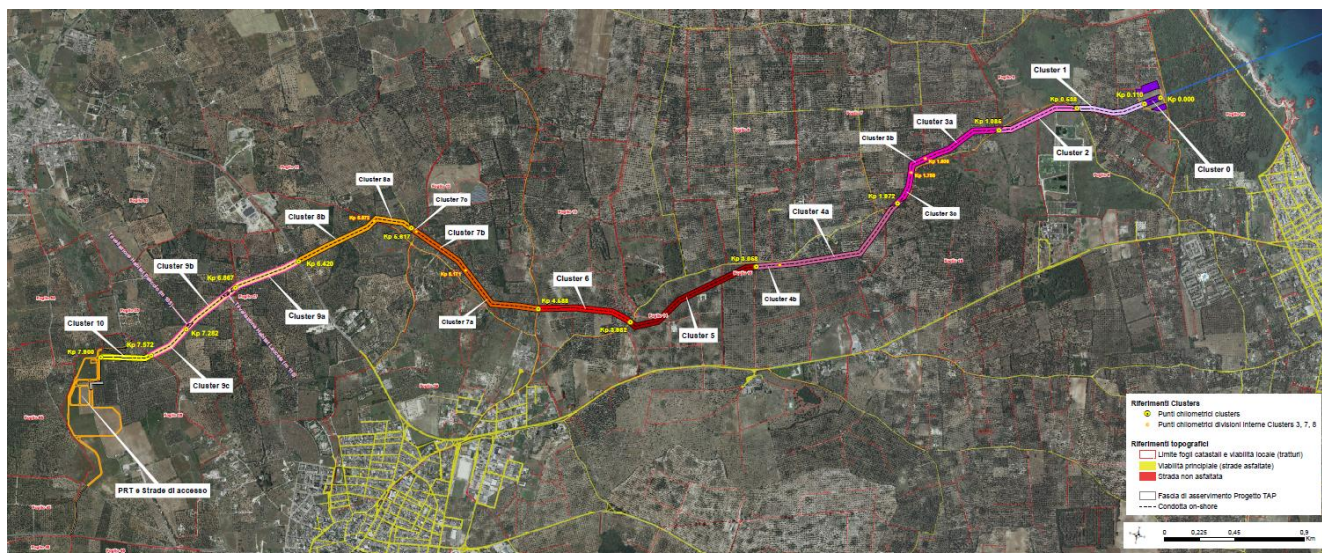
Layout dell'area di cantiere del tracciato dell'OPLI
